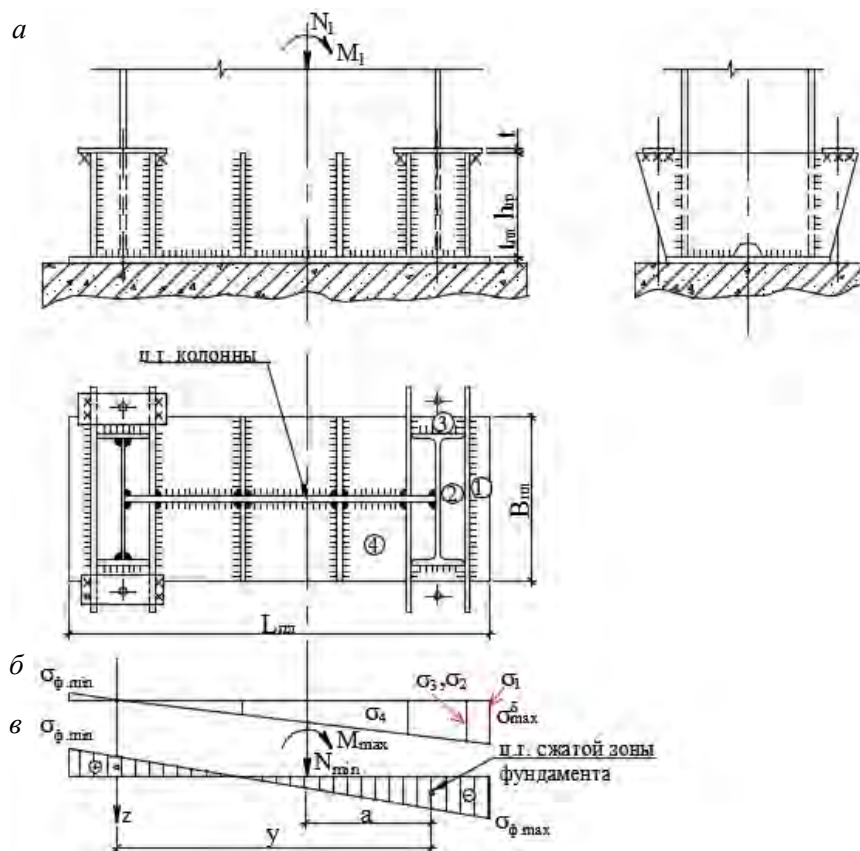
К расчету баз сплошных внецентренно сжатых колонн
